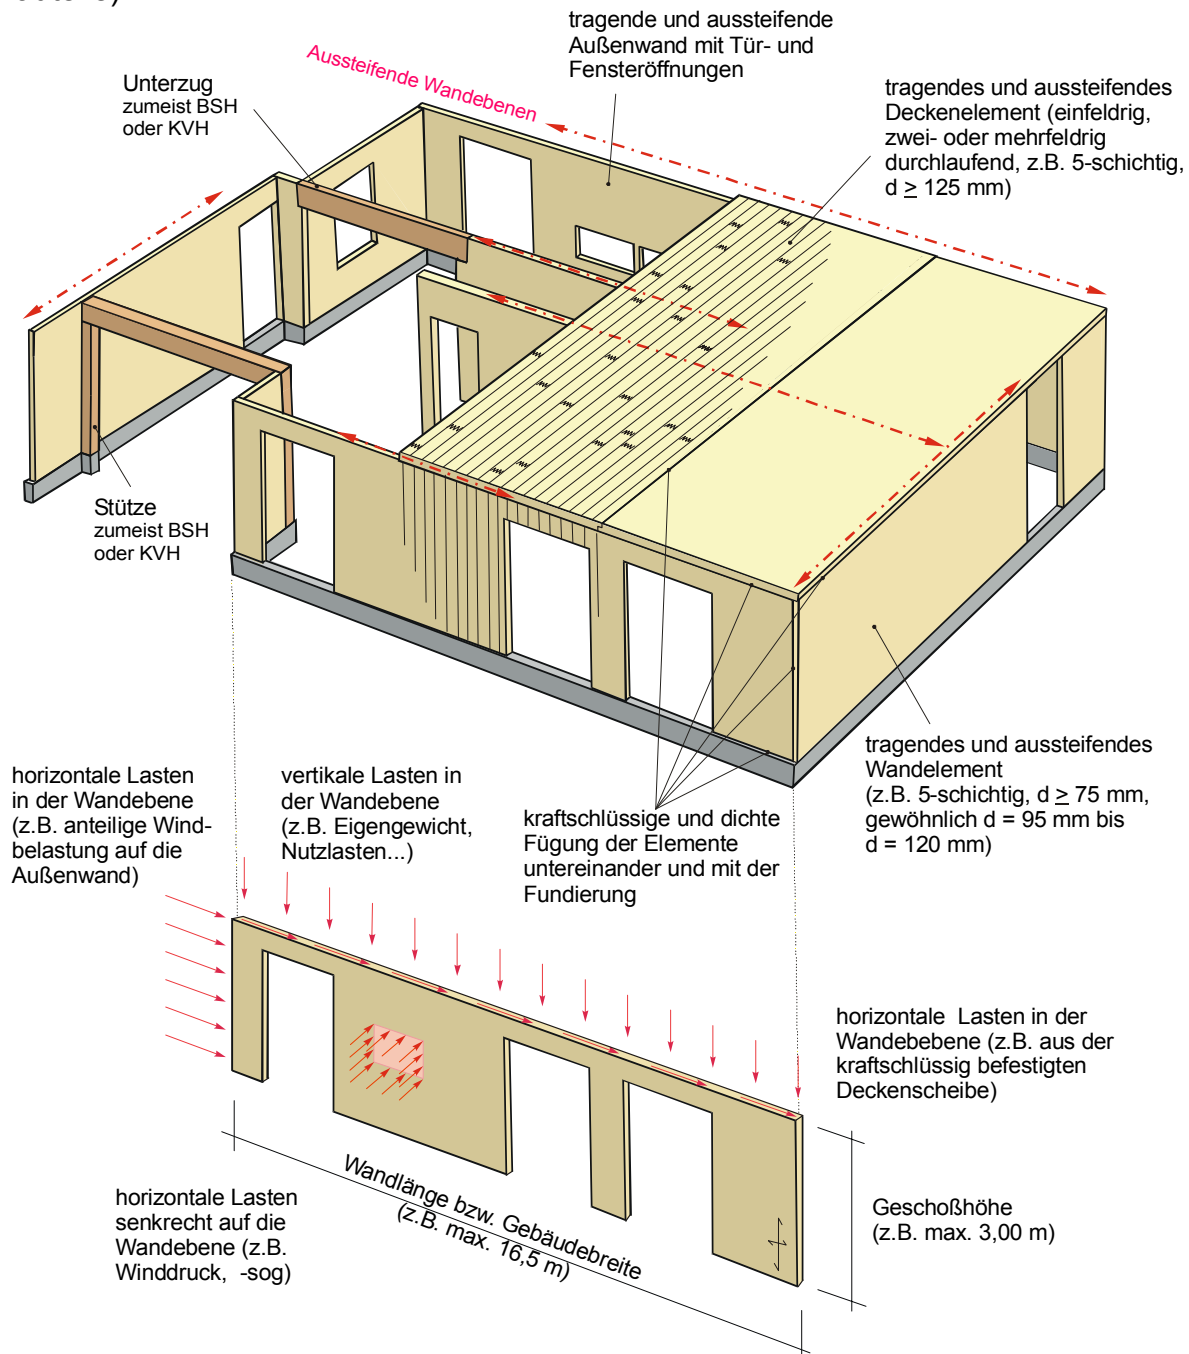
Einsatz von tragenden und aussteifenden BSP-Elementen. Beanspruchungen eines flächenhaften, gewöhnlich 5-schichtig aufgebauten BSP-Wandelementes
